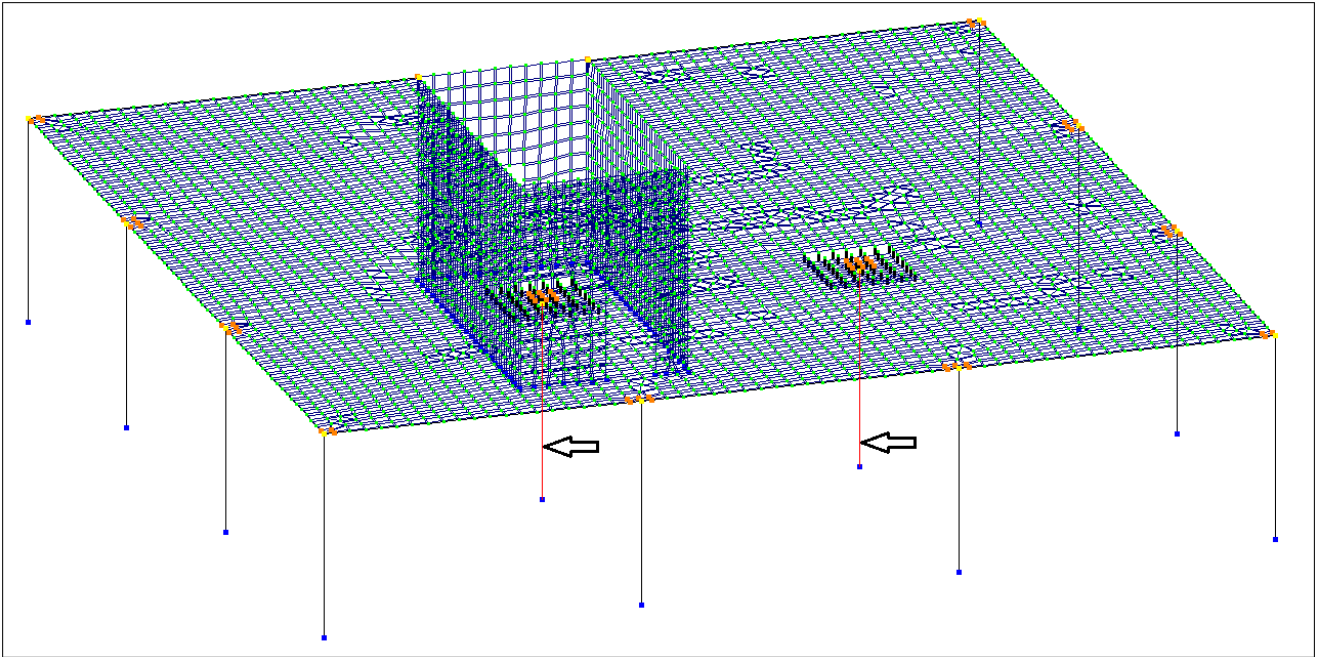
Схема 1 – го этажа с выделенными внутренними колоннами
